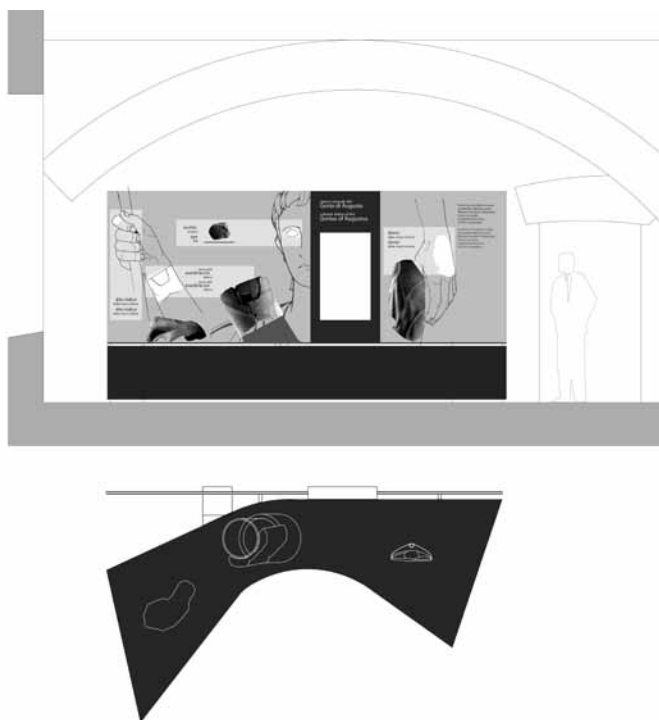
Museo dei Fori Imperiali. Sezione Foro di Augusto. Sala dedicata all’Aula del Colosso: prospetto e pianta del nuovo allestimento.
